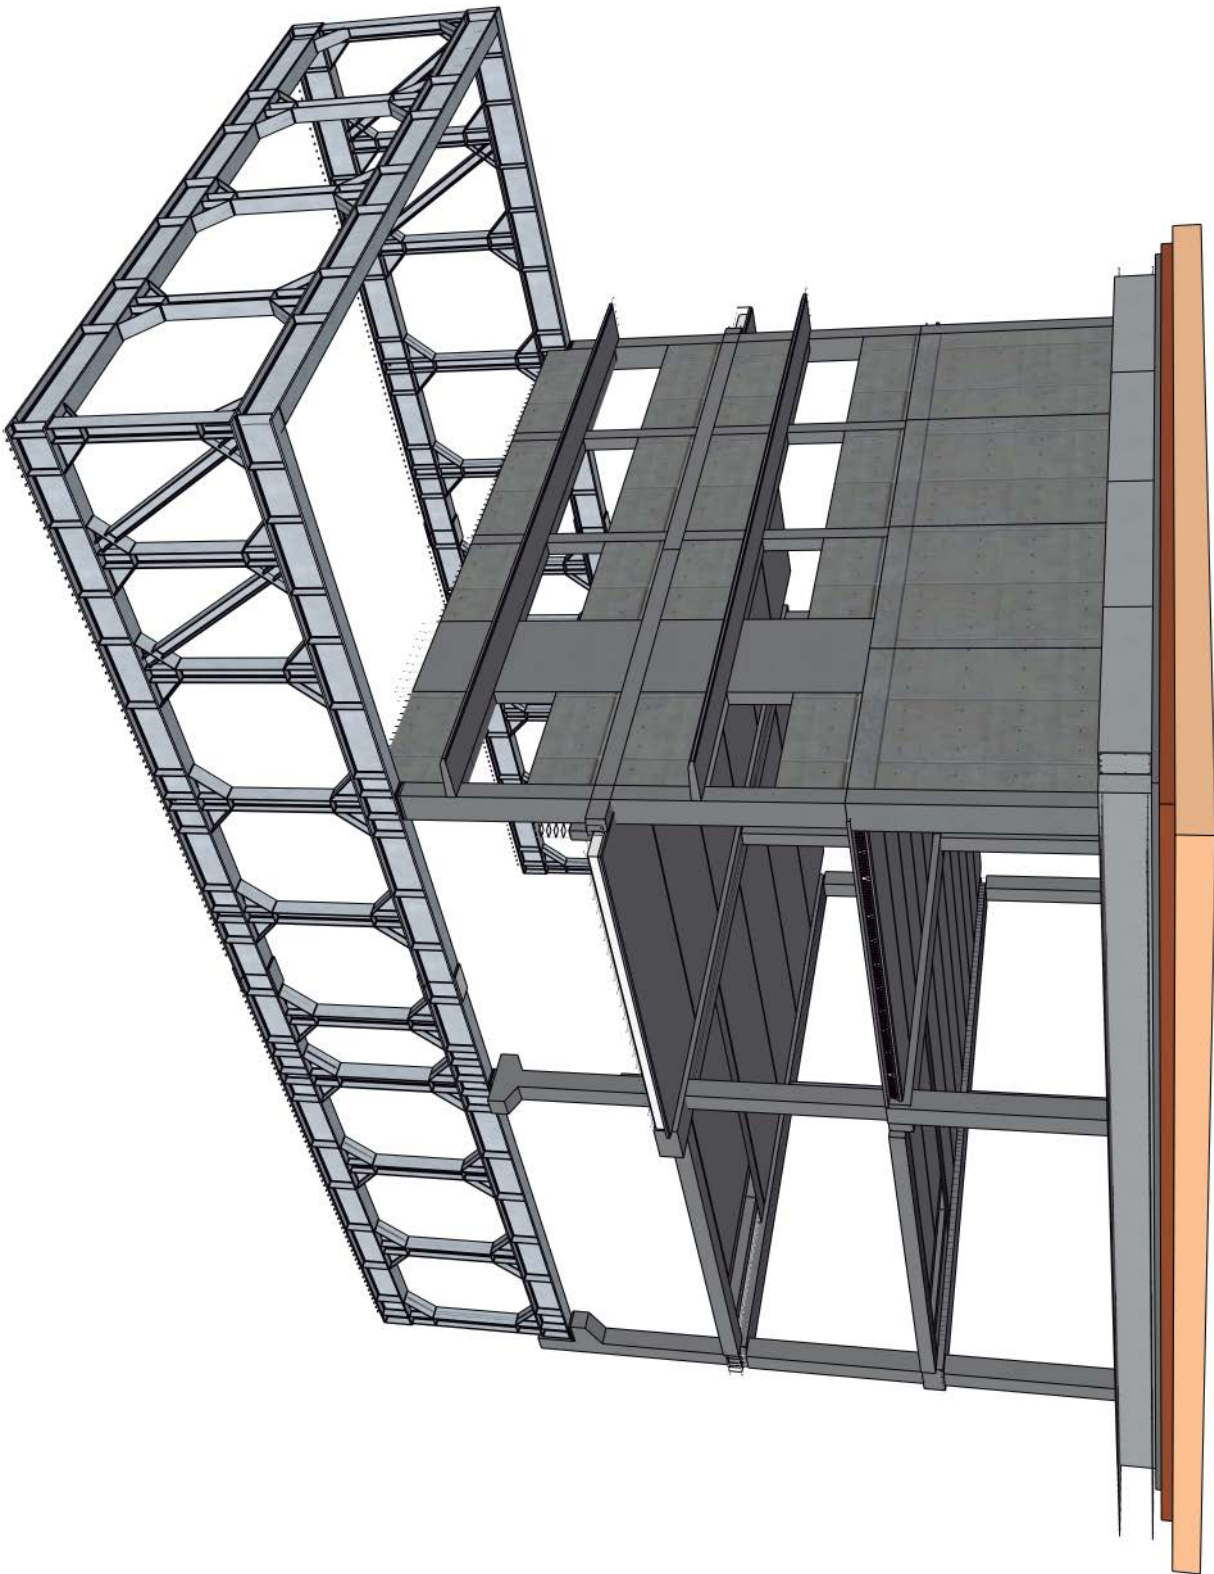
Colocación del tramo frontal de la estructura metálica del voladizo.
